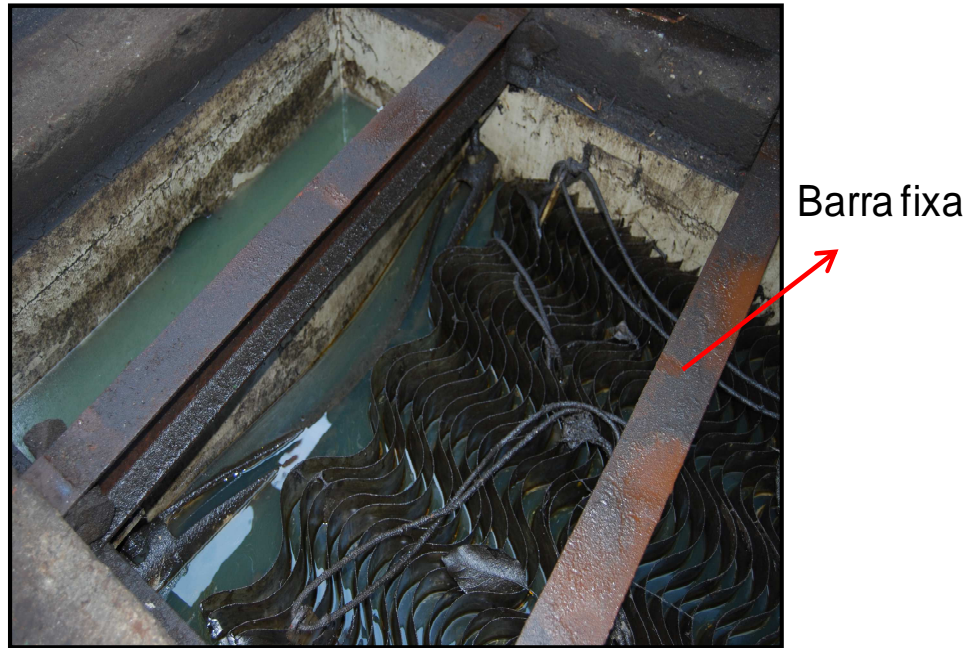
Vista superior do SAO com suas placas coalescentes instaladas no sentido perpendicular ao fluxo (sentido incorreto) e com barras fixas sobrepostas que inviabilizam a limpeza do equipamento.
